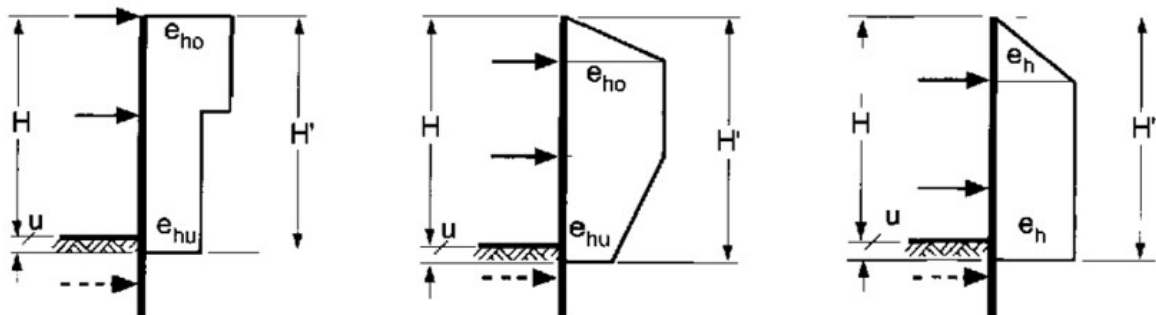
Recomendações da EAB para cortinas de concreto e estacas prancha com dois níveis de apoio (Weissenbach et. al., 2002)
